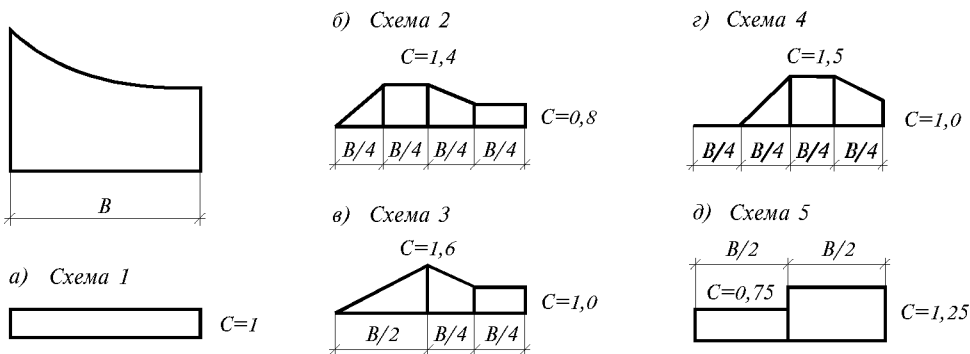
Снеговая нагрузка и коэффициенты  $\mu$  для цилиндрических оболочек на прямоугольном плане с разновысокими опорами
